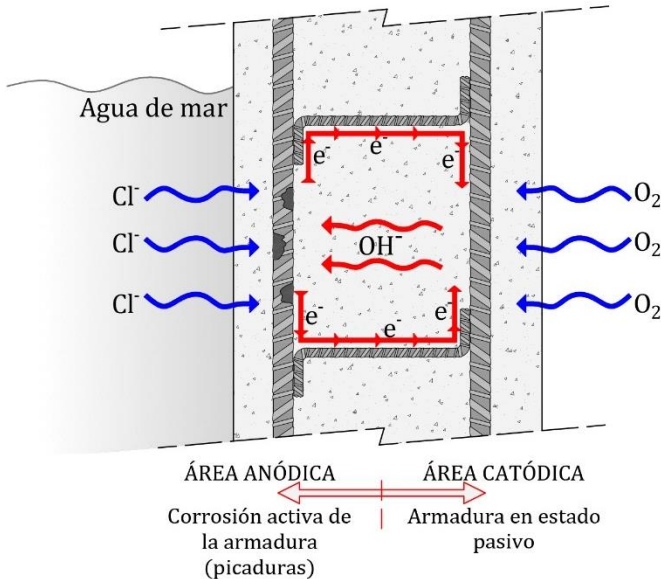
6- Esquema de macrocelda en muro de hormigón armado. Elaboración propia.
